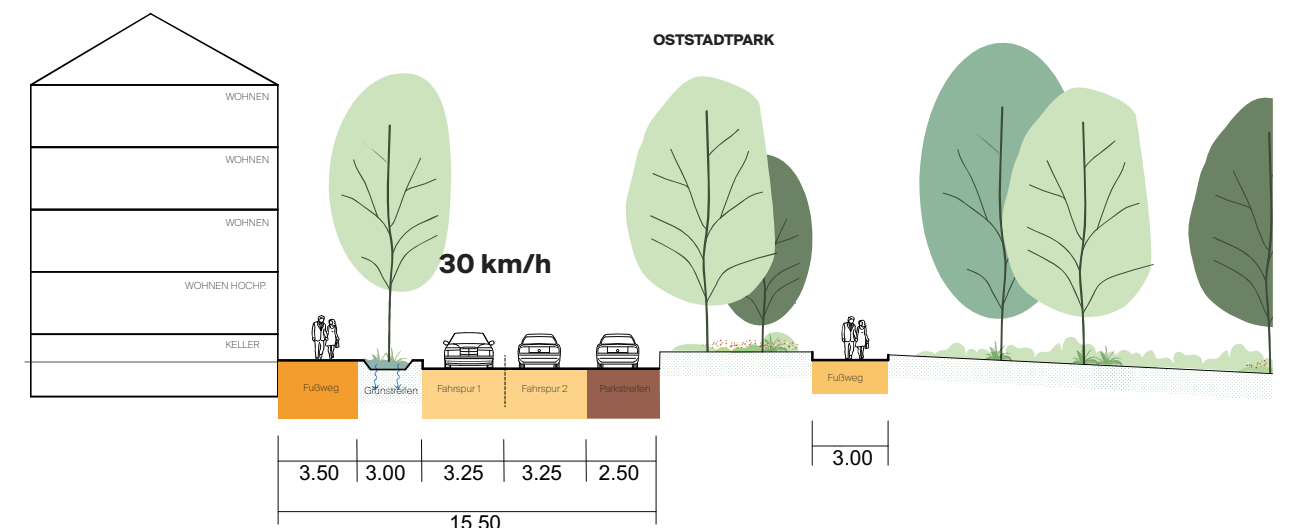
Schnitt „Oststadt-Park/Lindenstr.“ - Rahmenplan
